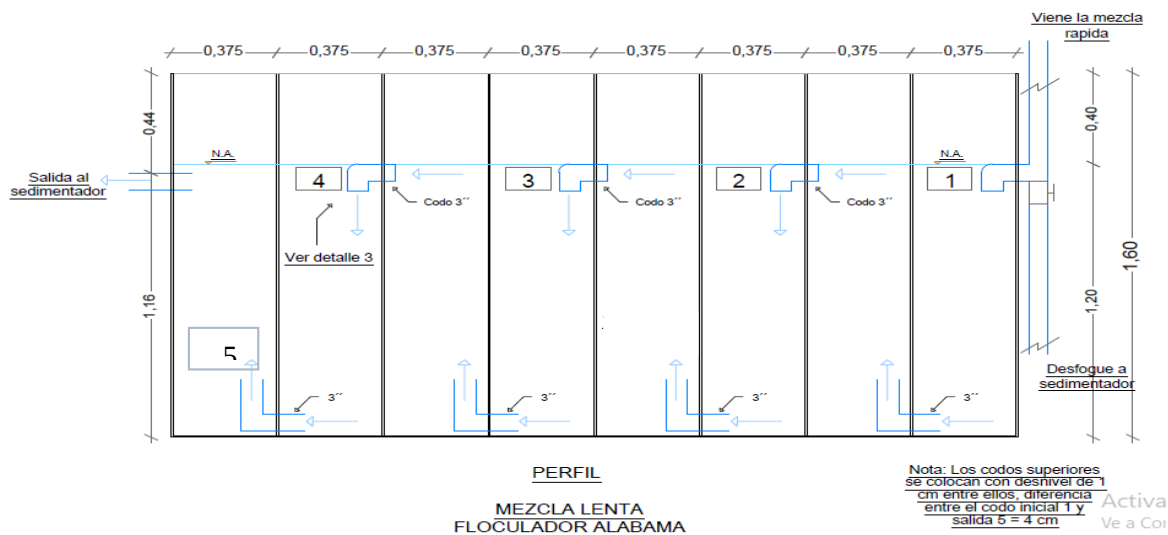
Vista de perfil longitudinal del floculador Alabama propuesto para el tratamiento
